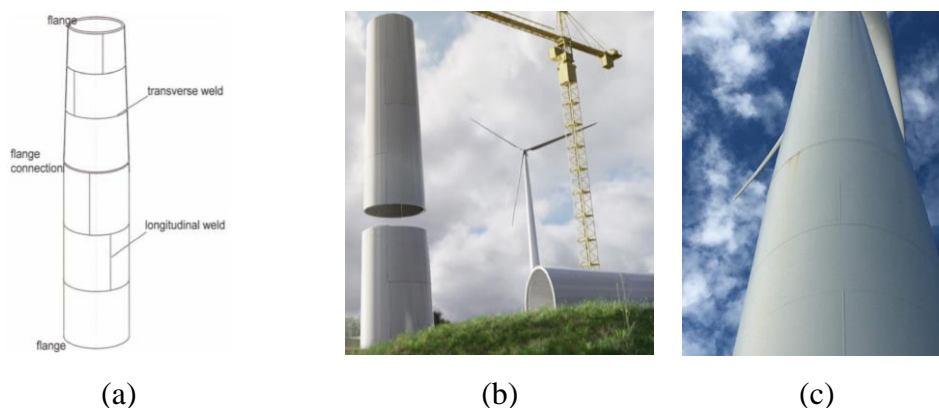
Torre metálica soldada: (a) esquema de conexões e solda; (b) içamento dos tramos e (c) torre com pontos de corrosão nas soldas dos flanges.
